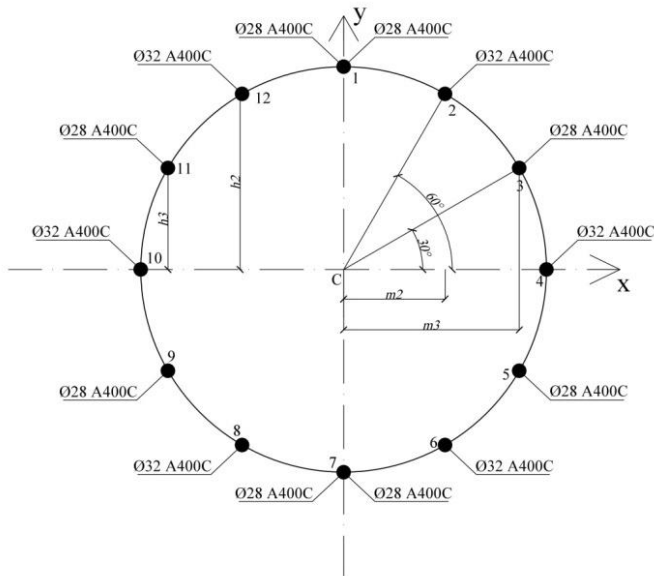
Переріз стику паль зі стінкою в перерізах з порушеннями шва бетонування
